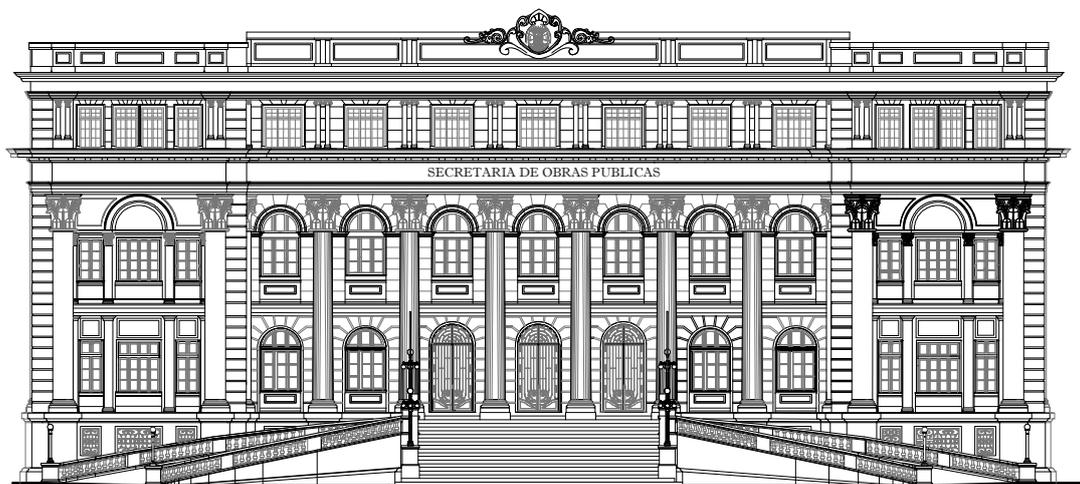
Redesenho da fachada principal da Secretaria de Obras Públicas com o acréscimo de um pavimento. Projeto de Barros.
